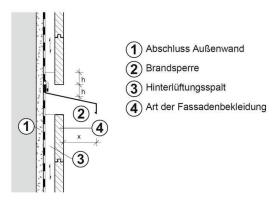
Schematischer Aufbau einer hinterlüfteten Holzfassade (aus dem Englischen nach "Structural Means for Fire-Safe Wooden Façade Design")
